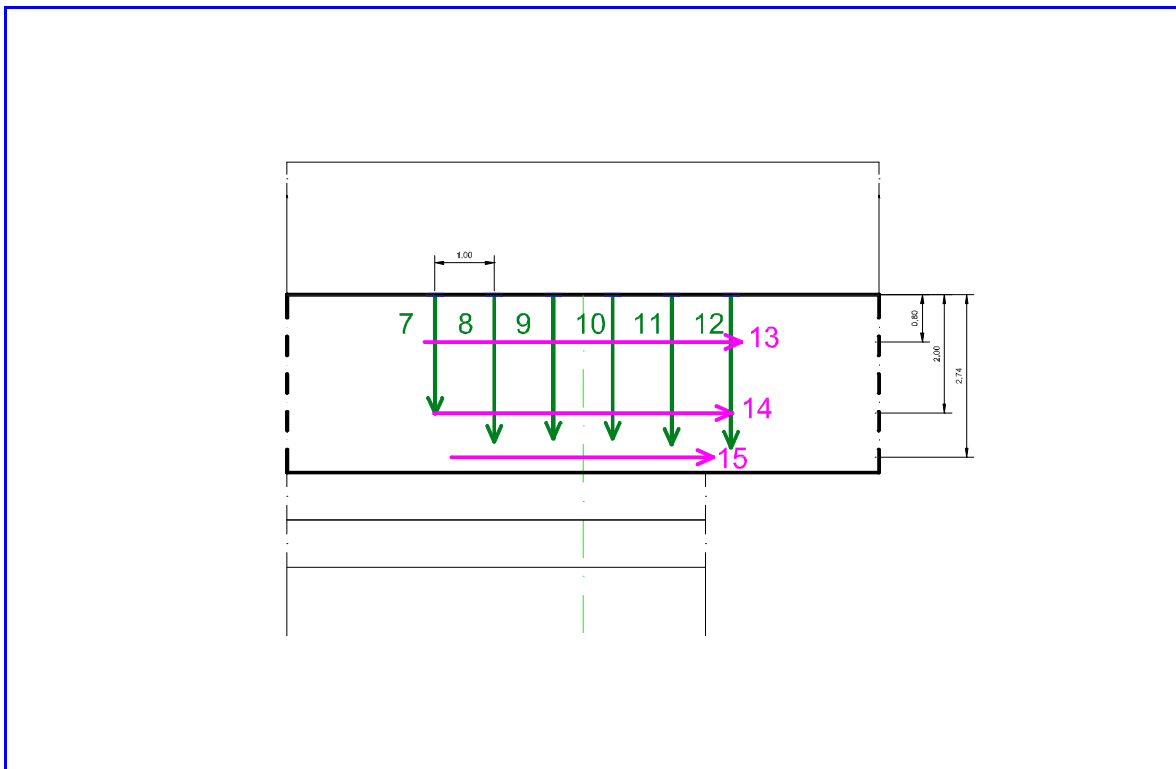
SP 34C - km 1+870 - Prospetto dell'area di prova
